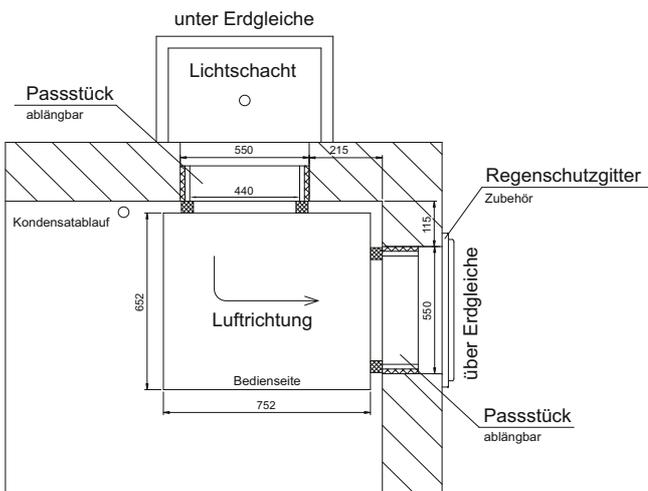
Eckaufstellung 500 mit bauseits gedämmten Mauerdurchbrüchen. Die Dämmung kann auch durch ein Passestück (Kanalteil) erfolgen (Abb. 2.8.13.1 auf S. 80)
